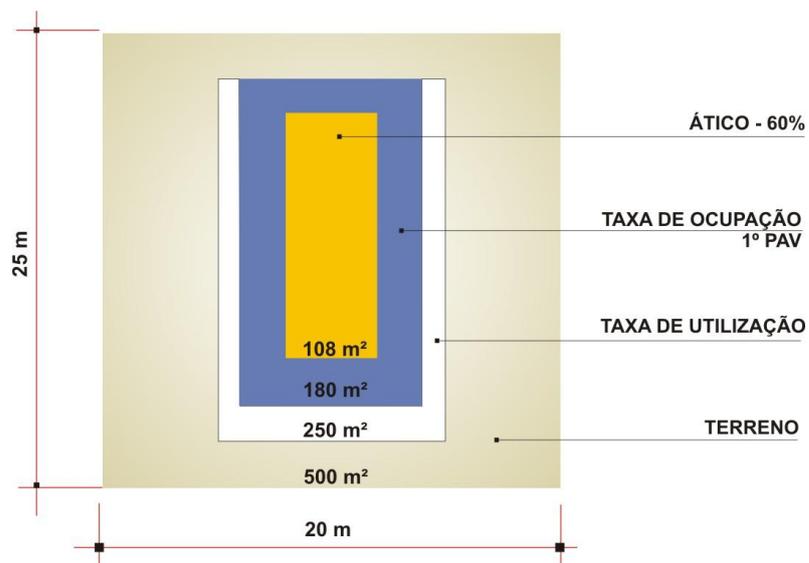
Parâmetros Construtivos – Taxa de Ocupação e Utilização
